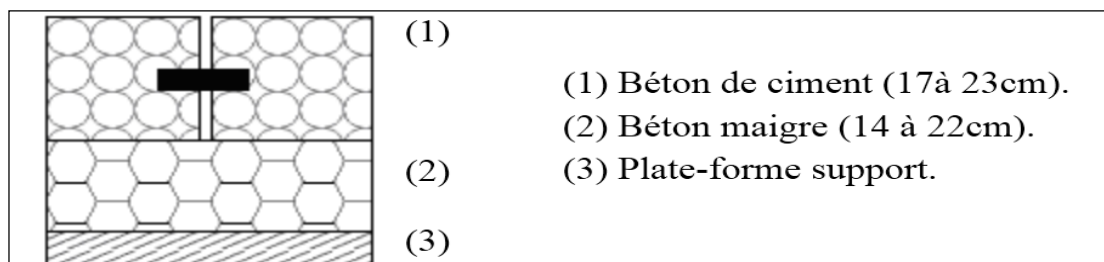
Structure d'une chaussée à dalles goujonnées avec fondation (MEZIANI, 2008)
